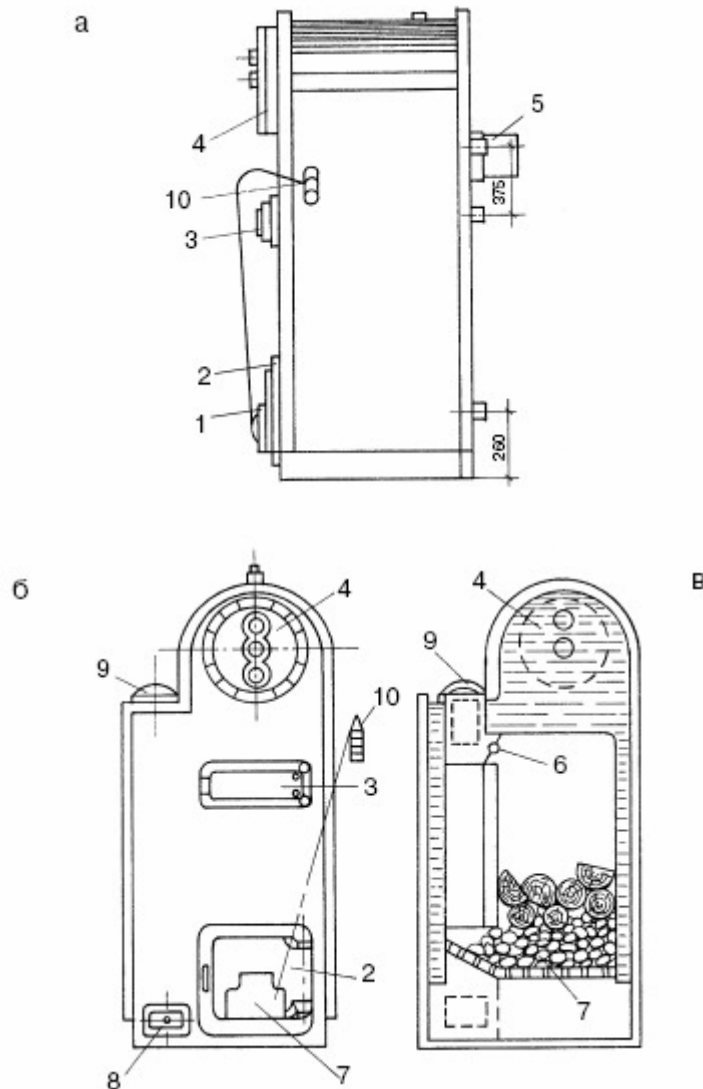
Котел с дровяной топкой из листовой стали: а – вид сбоку; б – вид спереди; в – поперечный разрез; 1 – дверца поддувальная; 2 – дверца прочистная; 3 – дверца топочная; 4 – регулятор горения; 5 – водонагреватель; 6 – дымовой патрубок; 7 – колосники; 8 – чистка с песчаным затвором; 9 – дроссель (открывающийся при растопке и закрывающийся при установившемся горении); 10 – трубчатый нагреватель через колосники, а вторичная – в надтопливное пространство.
